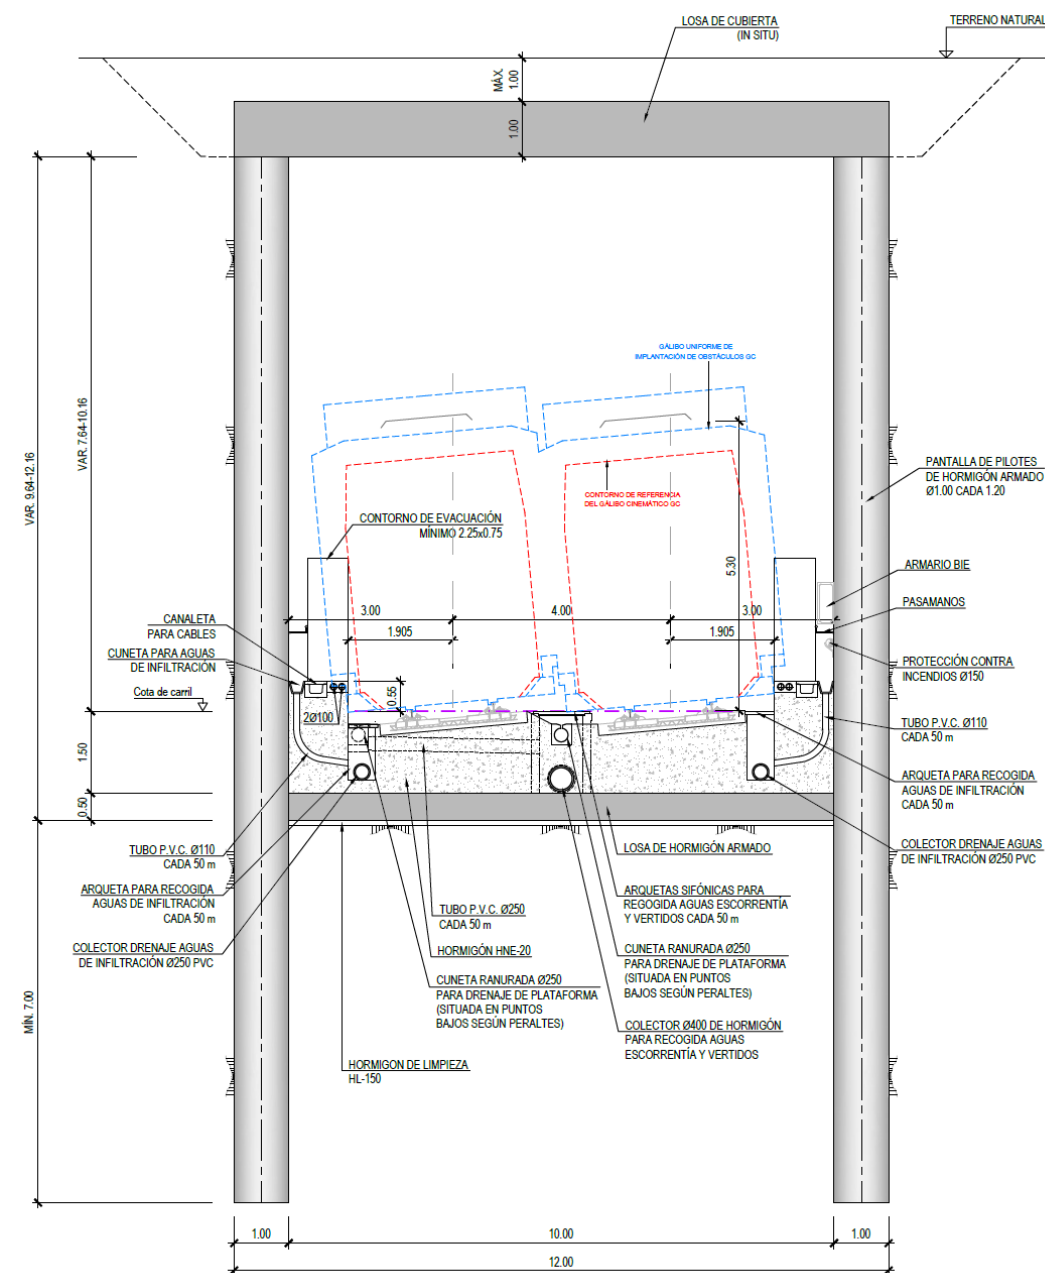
e.- Sección tipo 4 en el tramo soterrado (ST-S4).
